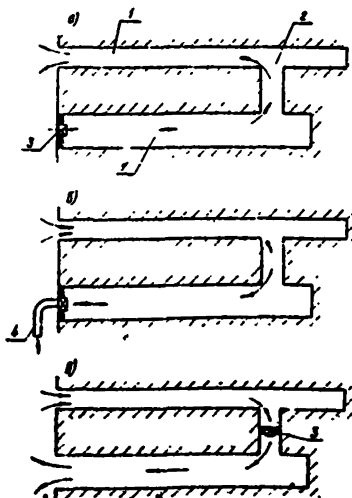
Рис. II. Схемы сквозной вентиляции, варианты а, б, в, установки вентиляторов:
